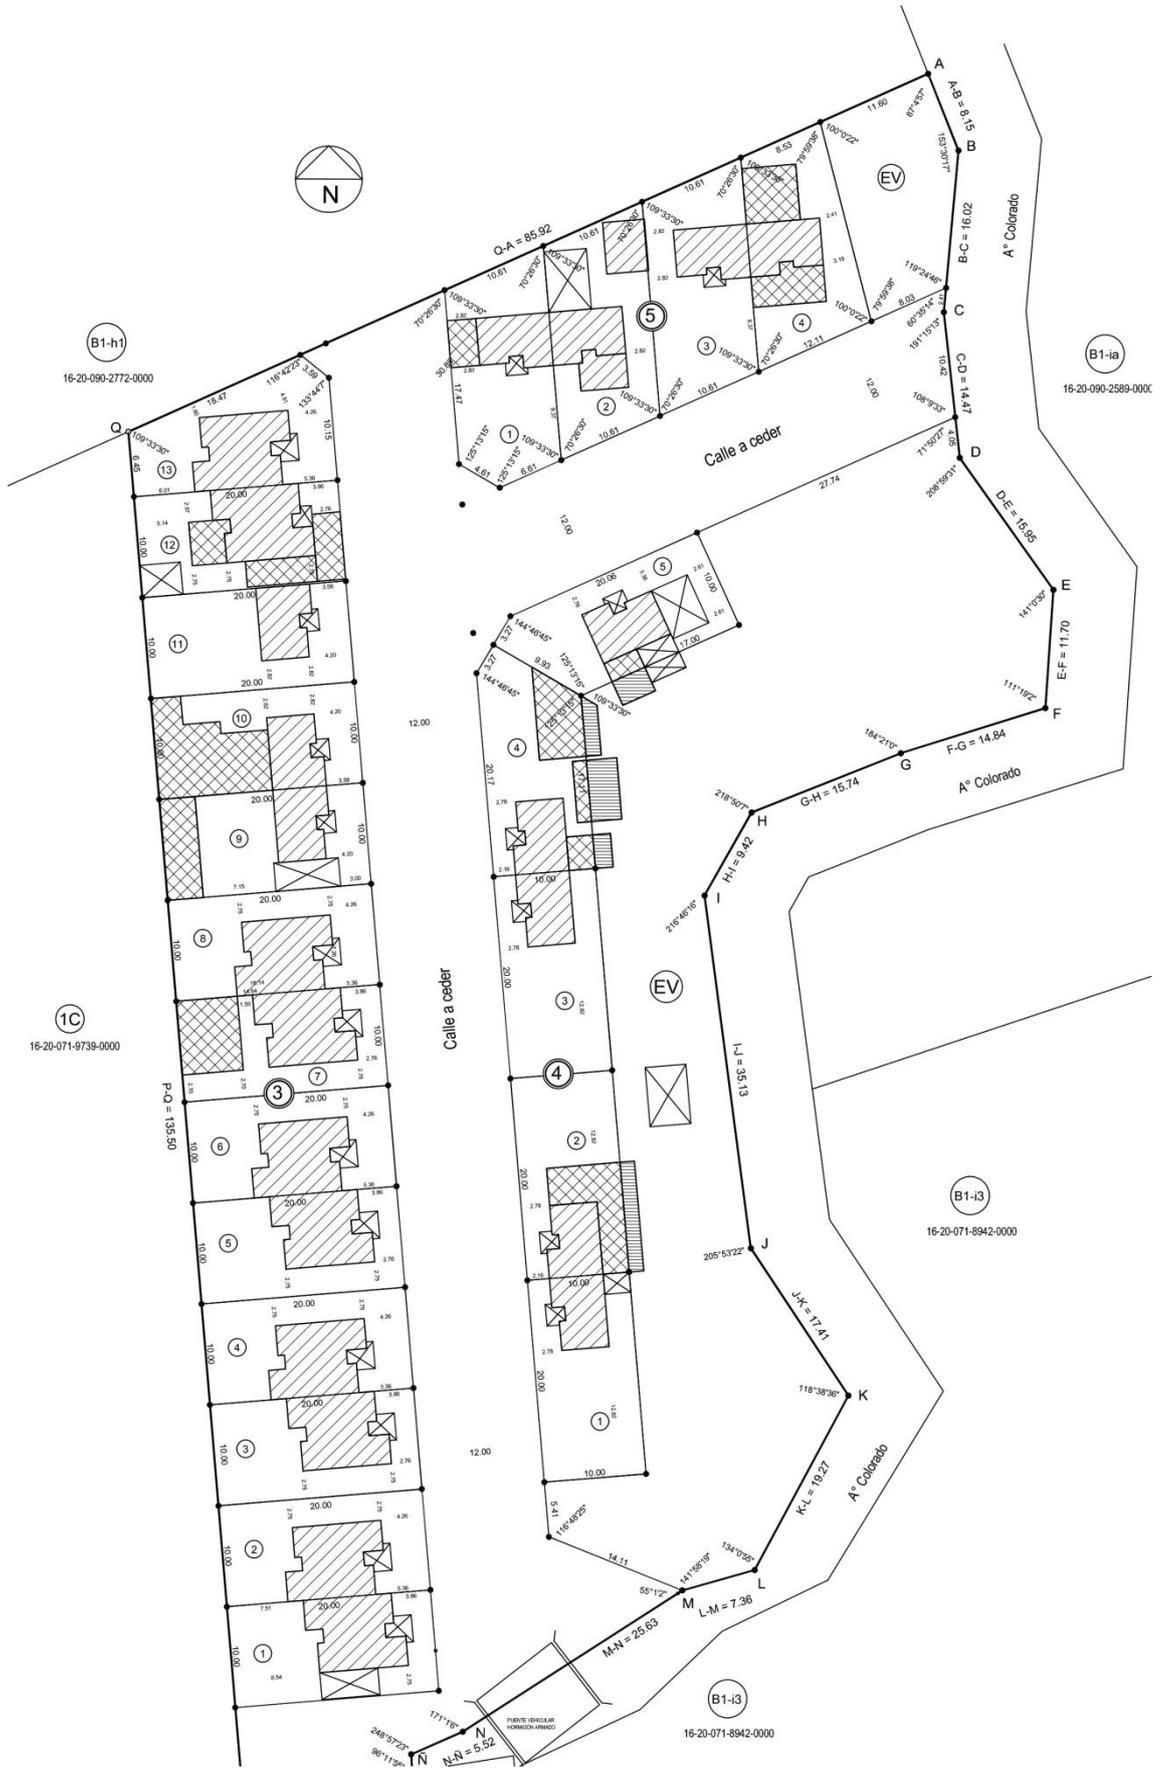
Plano de ubicación de las construcciones Lote B1-h3
